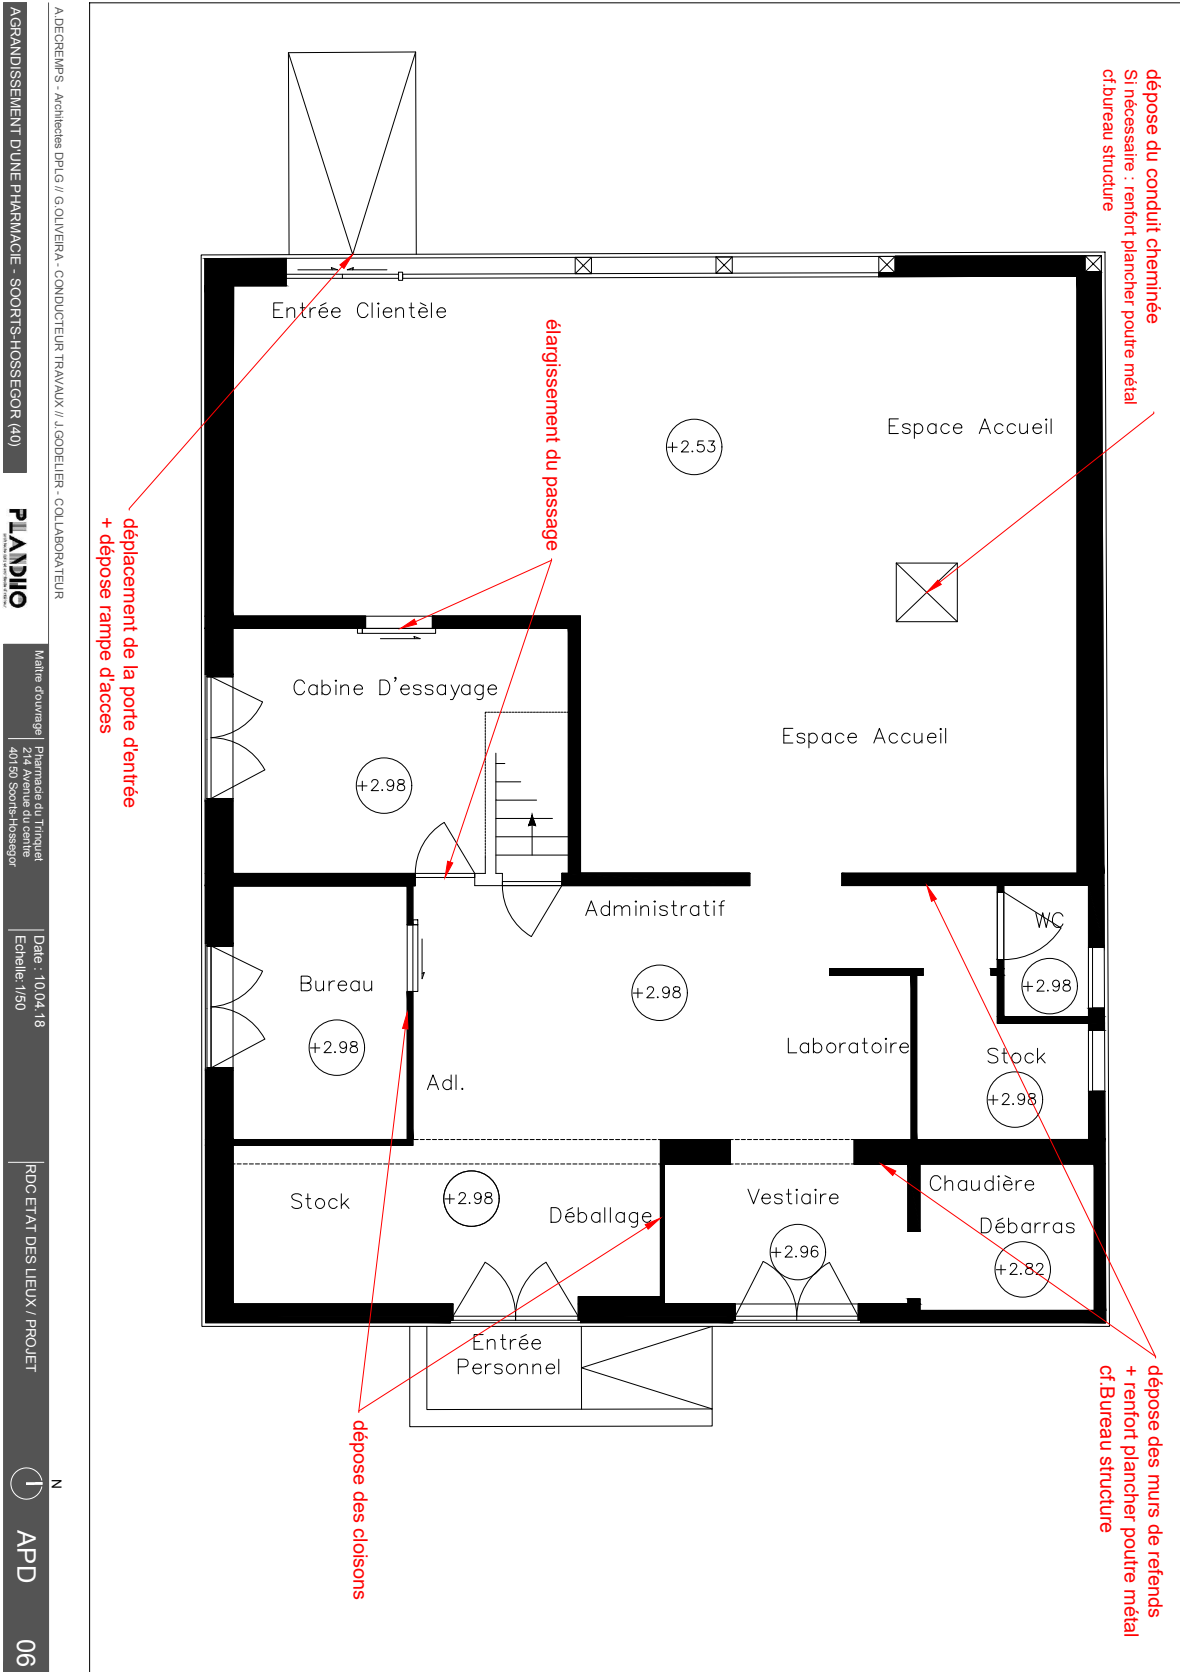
Plan des travaux de gros œuvre à réaliser pour le projet de la pharmacie du Trinquet (Rez-de-chaussée)
